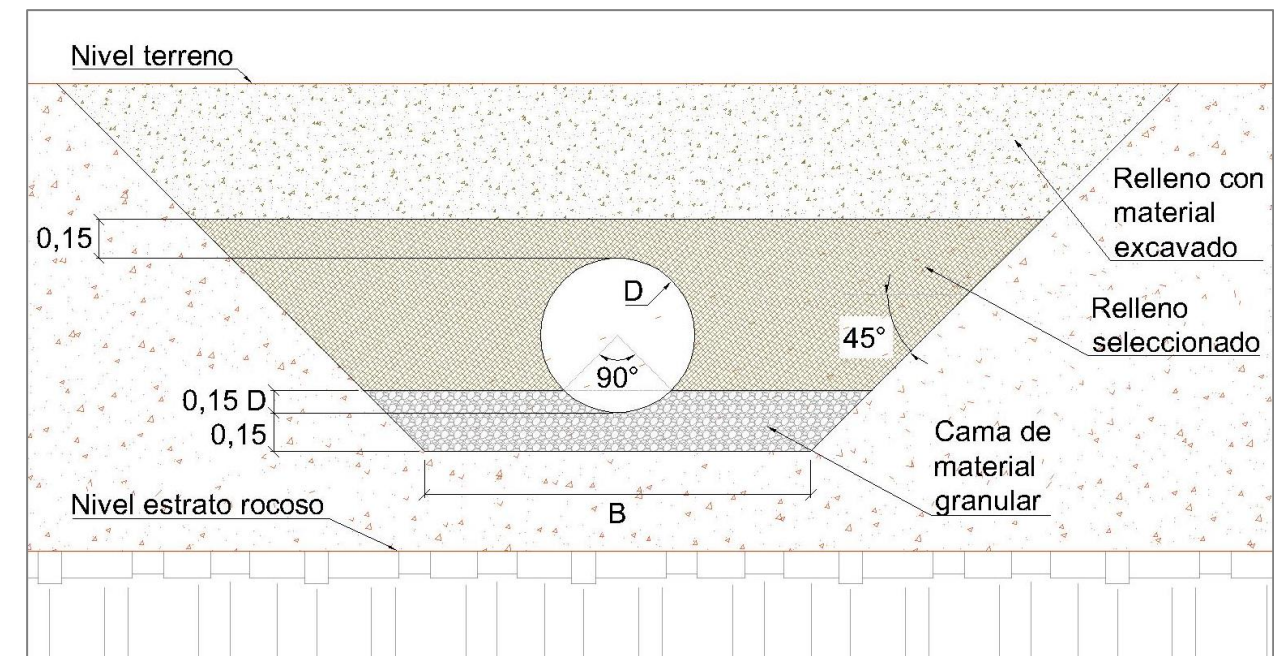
Sección transversal tipo en zona sin aparición del estrato rocoso. Fuente: Elaboración propia
